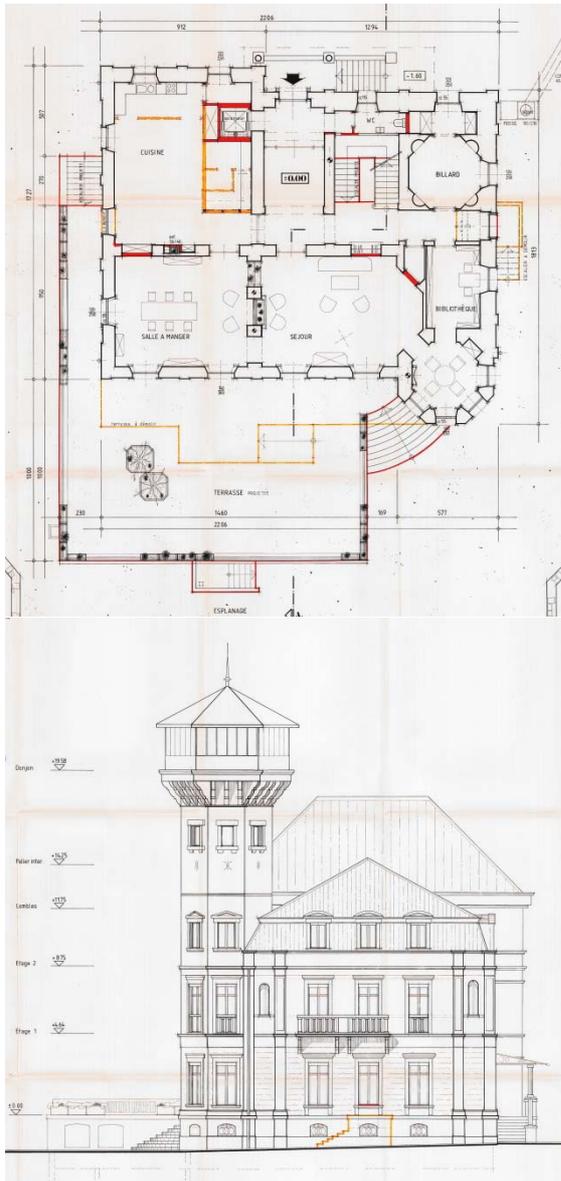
et 6b, Plans du rez-de-chaussée et de la façade est 1989, Commune de Montreux, Police des constructions, AM-MTX-G-e4617
